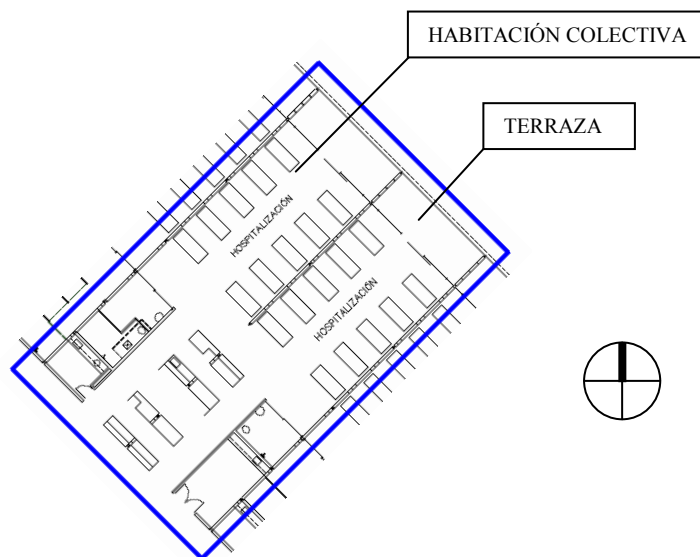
Modelo Sarah Salvador - Planta baja de hospitalización (archivo del CTRS adaptado por la autora)
